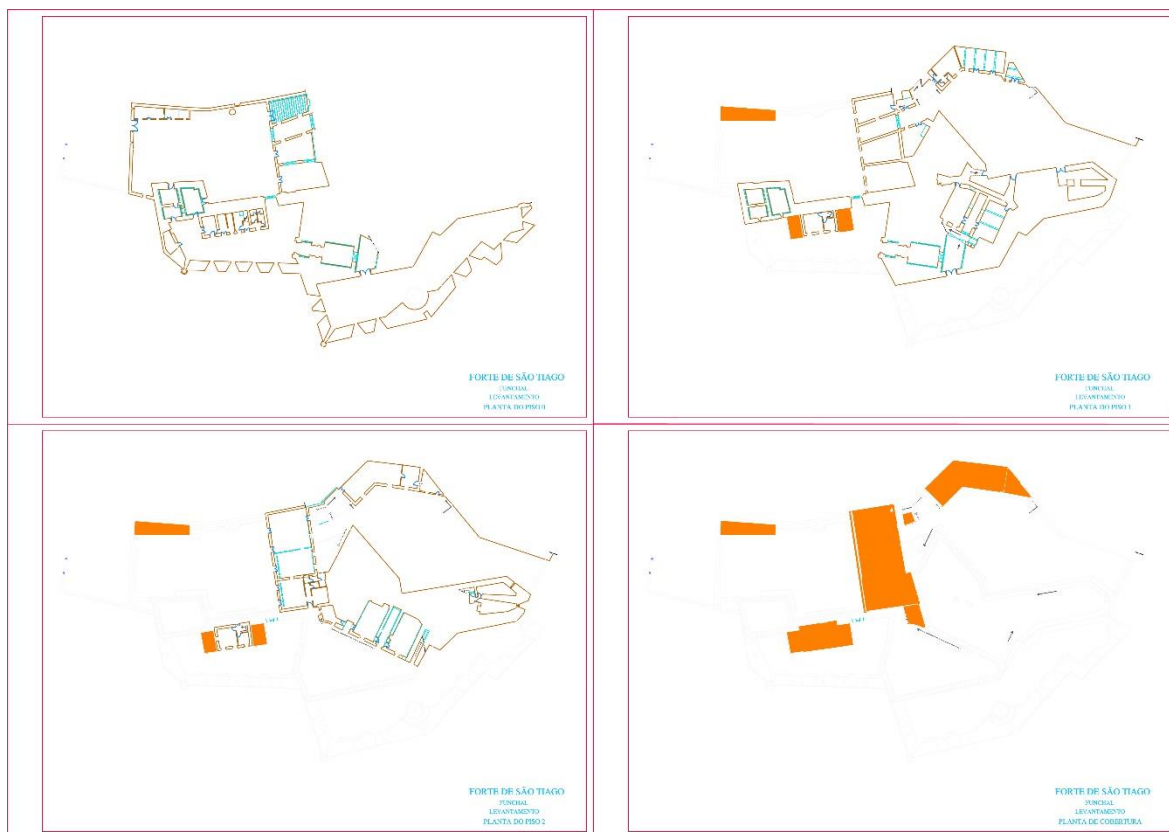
Planta de referência por pisos (piso 0, piso 1, piso 2, planta de cobertura)
